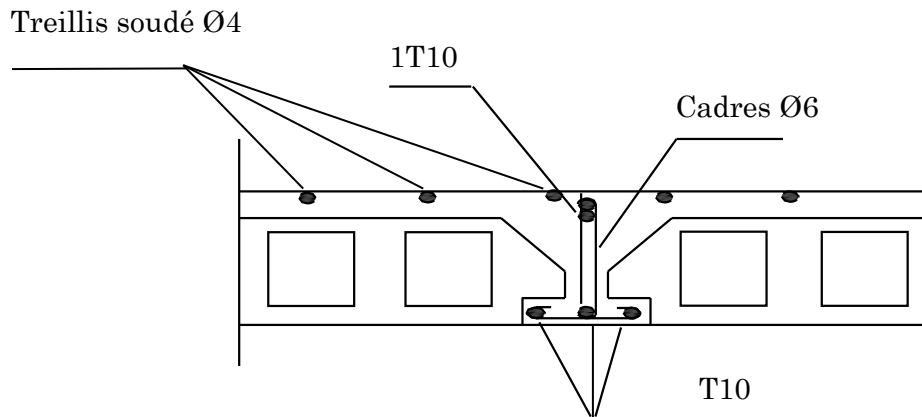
Ferrailage de la poutrelle et de la dalle de compression
